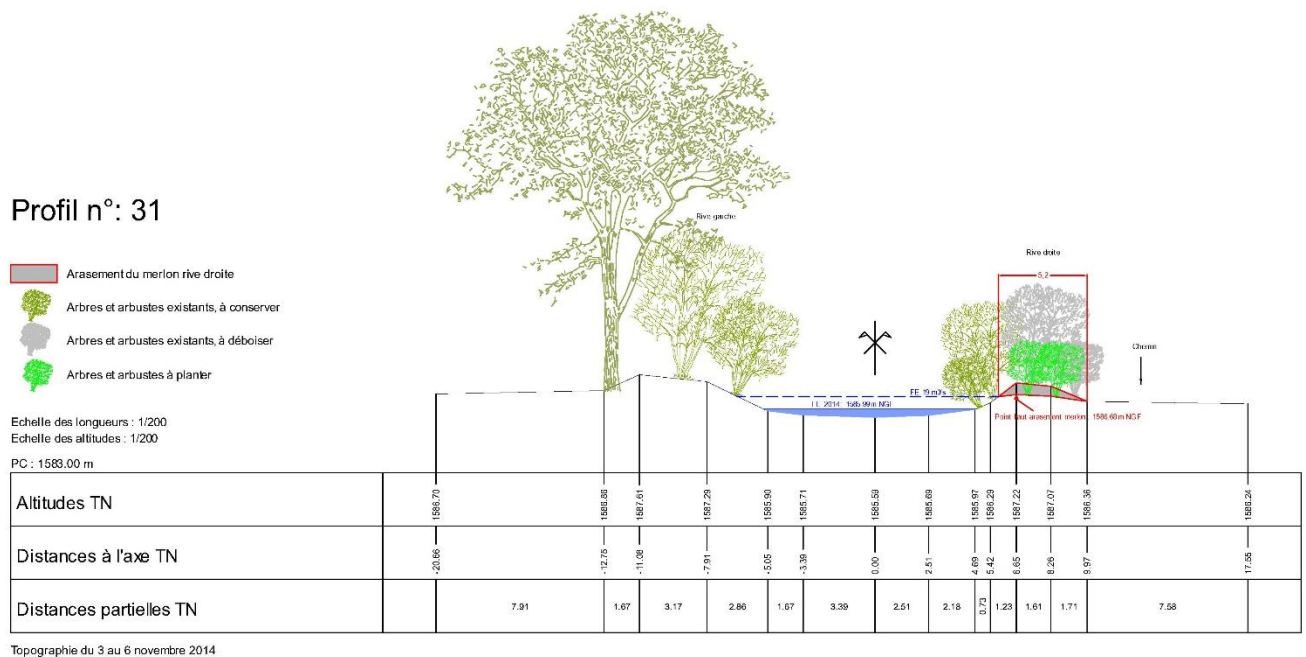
Profil en travers 31 de l'arasement du merlon rive droite à Ville Basse
